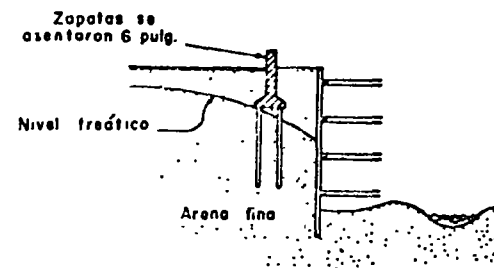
EJEMPLO DONDE ASENTAMIENTO DE EDIFICIO ADYACENTE SE DEBIO A SIFONAJE POR LEVANTAMIENTO.
